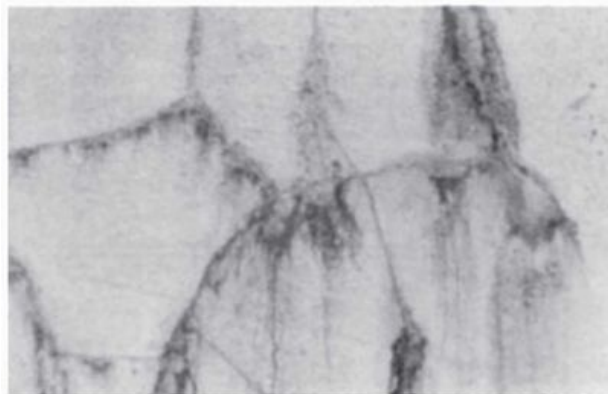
Fissuras causadas por perda de aderência das barras da armadura
